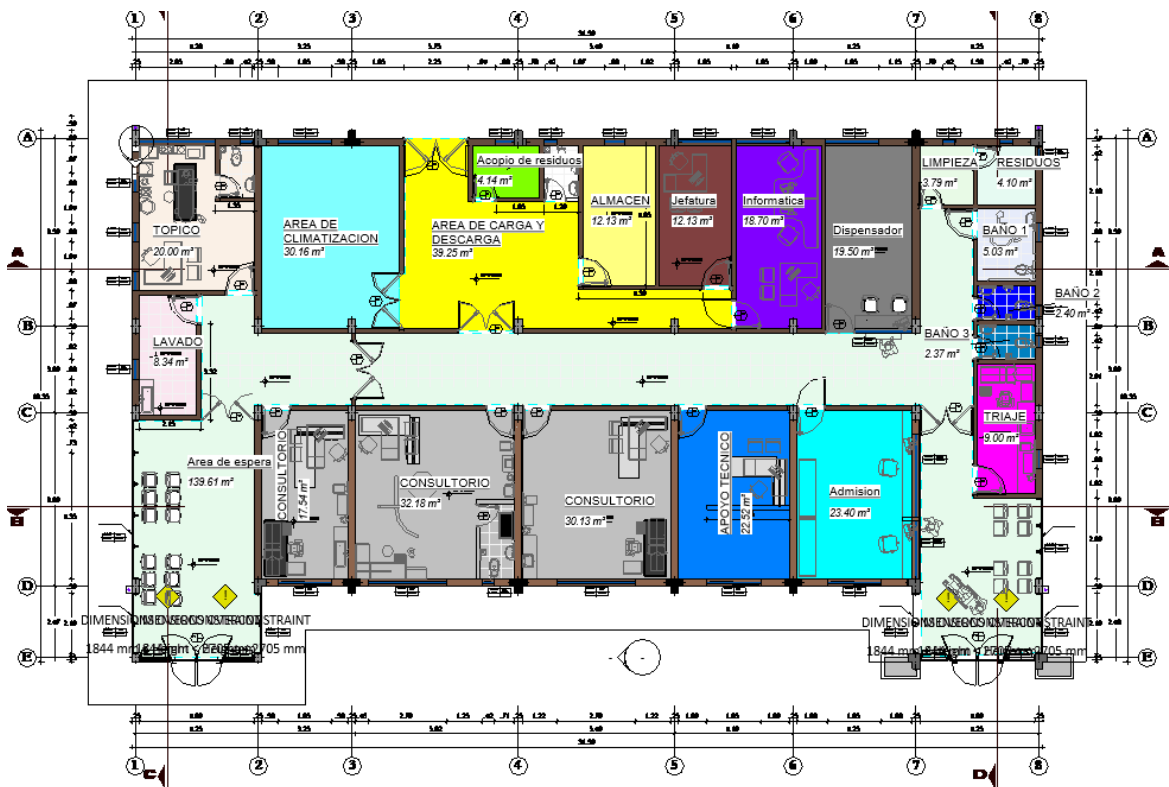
de anexo 9. Distribución de las áreas en planta en el diseño arquitectónico.
